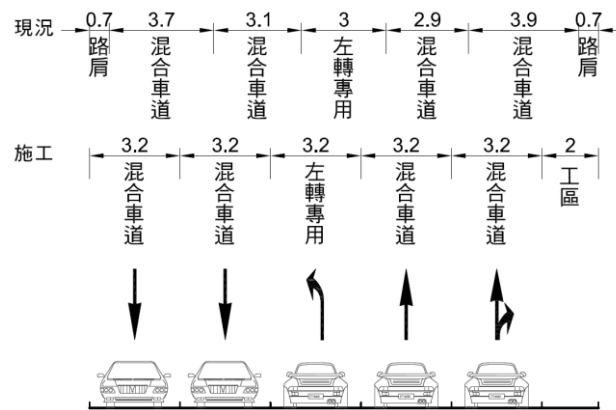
民族路 U 型溝施工斷面配置示意圖
